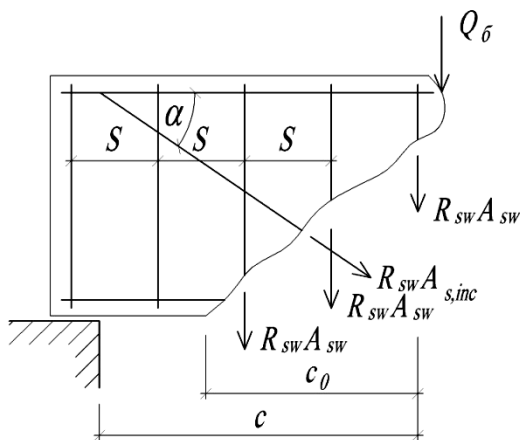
Расчётная схема усилий в наклонном сечении железобетонного элемента при расчёте на поперечную силу
